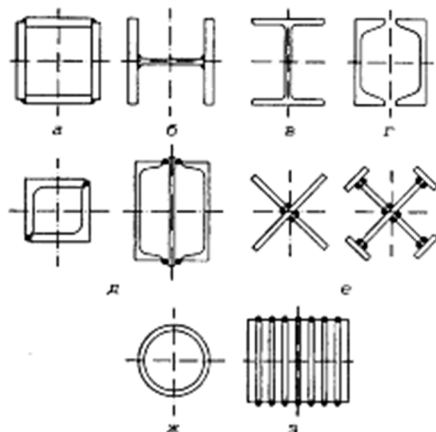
Перерізи колон багатоповерхових будинків: а – зварний квадратний із чотирьох листів; б – зварний двотавровий; в – широко полчкові двотаври; г – зварений з двох кутиків або швелерів; д – те ж, підсилений центральним листом; е – зварний перехресний і перехресний, підсилений листами; ж – кільцевий з труб; з – зварний з пакета листів
